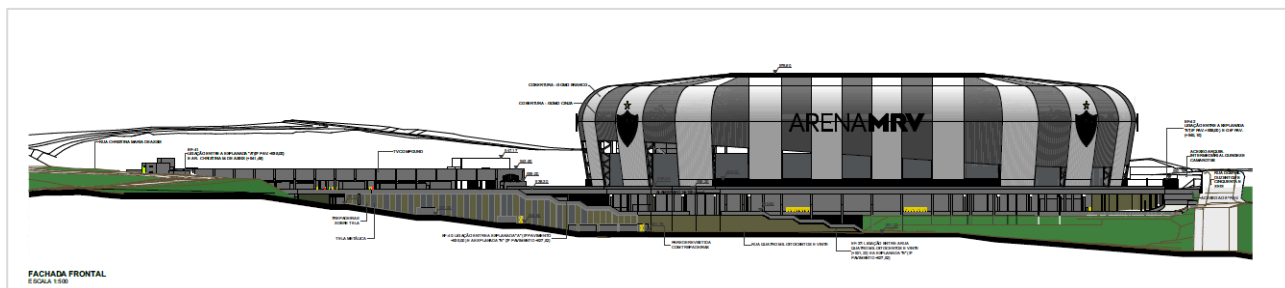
Vista Fachada Frontal. Fonte: Fonte: Prancha Projeto arquitetônico, Farkasvölgyi & Arquitetos Associados Ltda, 2025.
